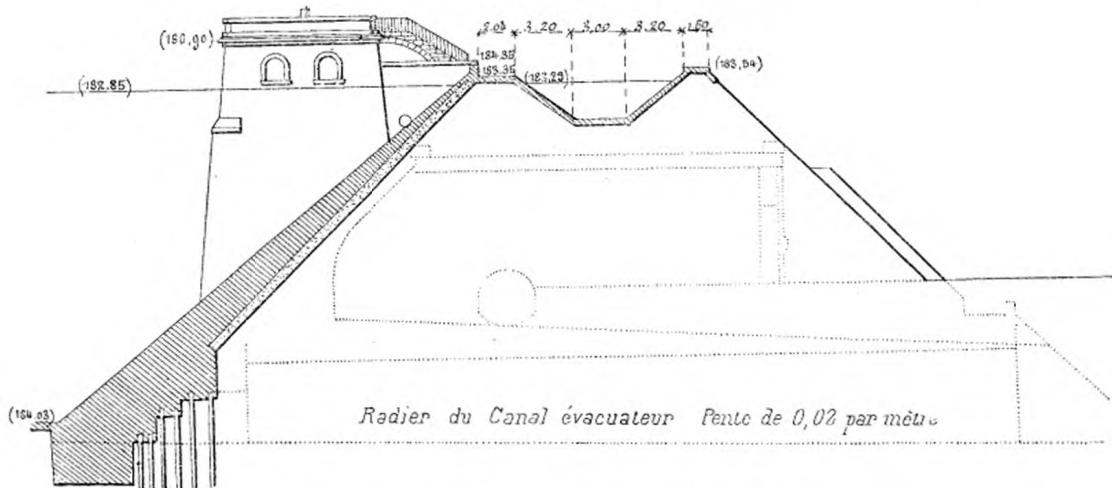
Coupe transversale du Barrage, Elévation latérale du Pavillon des Siphons.
